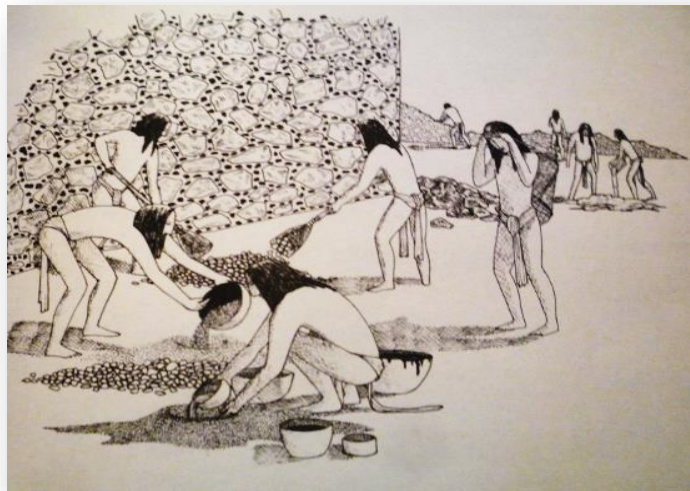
Sistema constructivo de muro de mampostería de Piedra.
